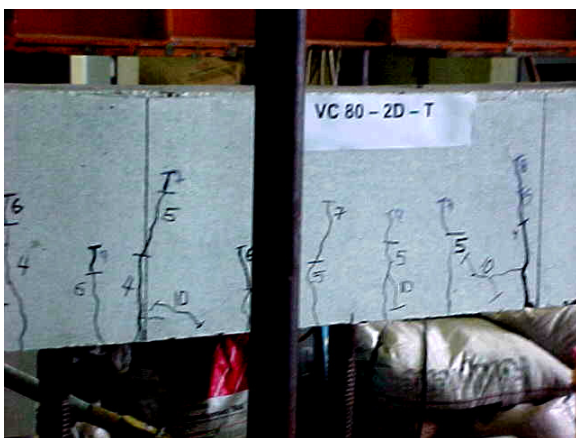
Vista da face lateral e inferior da viga de referência VC80-2D-T com o mapa da fissuração, após a realização do ensaio.
